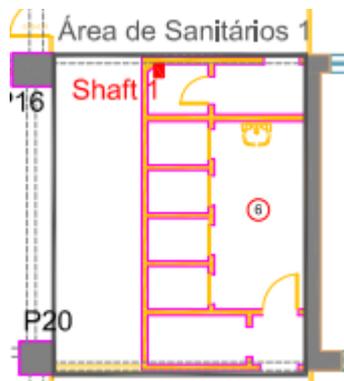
Planta de demolição – localização da área dos sanitários existente (3º pavimento)
